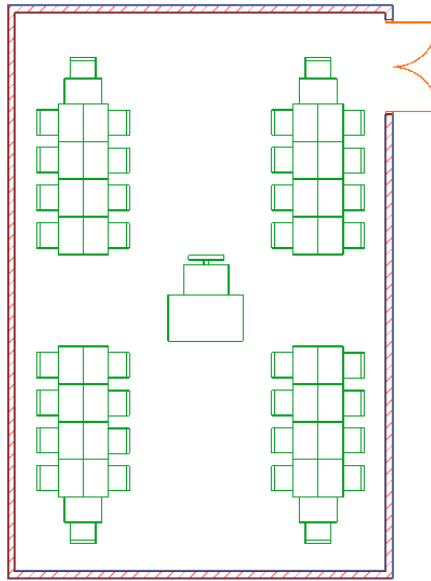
Alternatif A Konsep Layout Ruang Kelas *Collaborative
